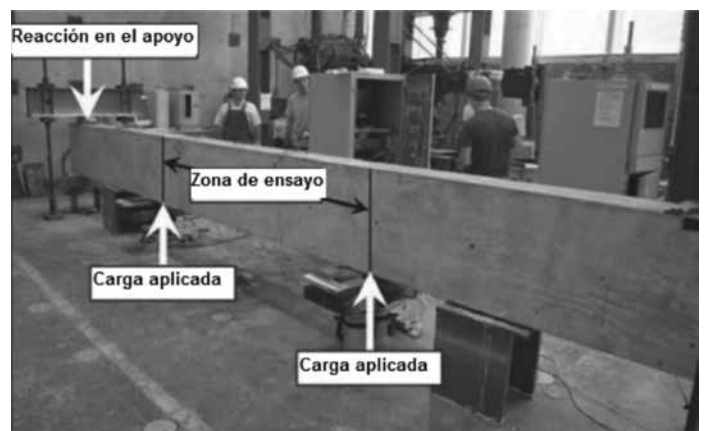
Montaje del ensayo para vigas con traslajos probadas en la Universidad del Estado de Carolina del Norte.
